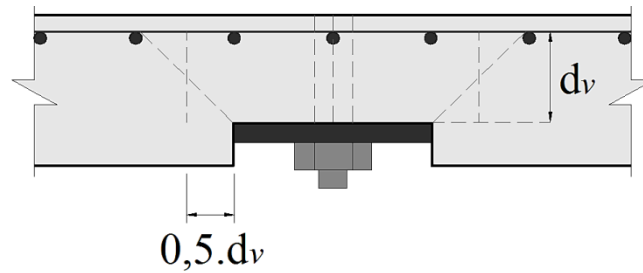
Altura útil efetiva da laje considerando a penetração do pilar na laje ( $d_v$ )
